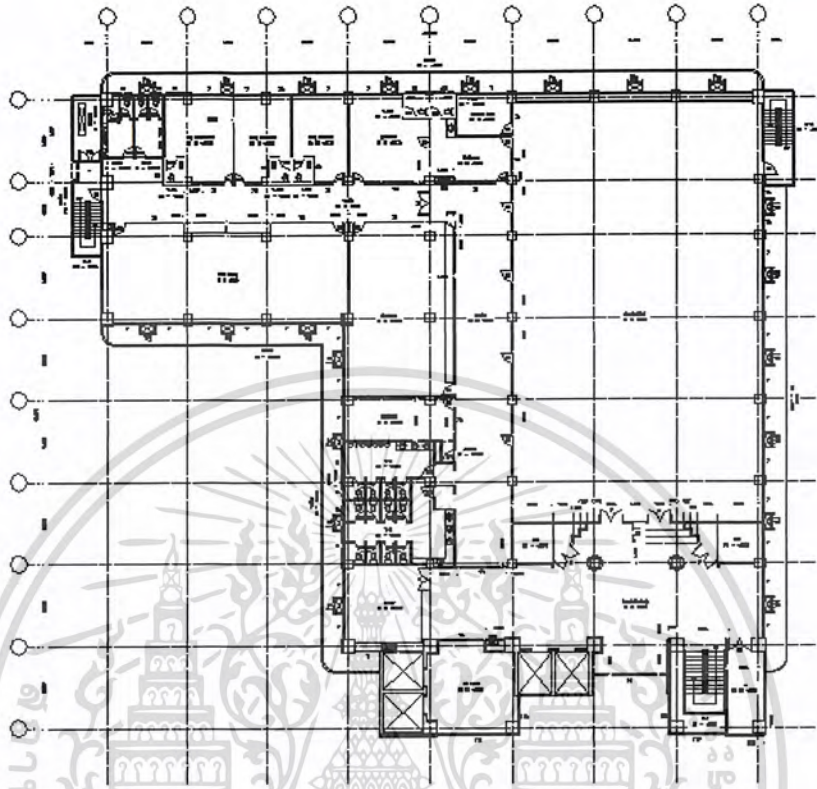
แสดงพื้นที่ชั้น 8 th FLOOR PLAN
